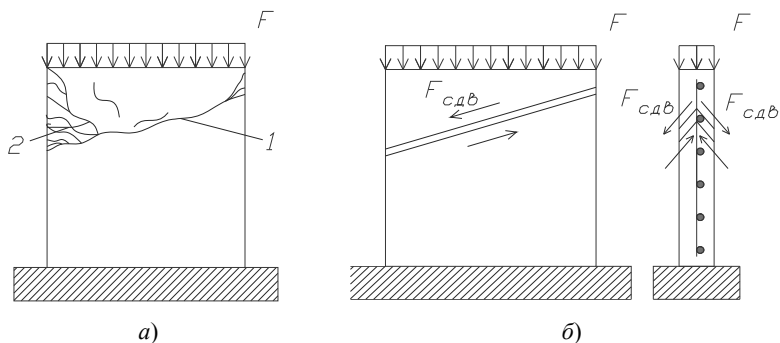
Испытание модели стены, армированной арматурной сеткой, под действием распределенной нагрузки:
